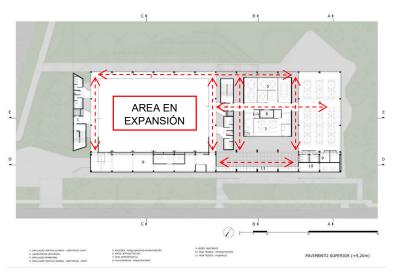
Planta arquitectónica, circulación segundo nivel.
